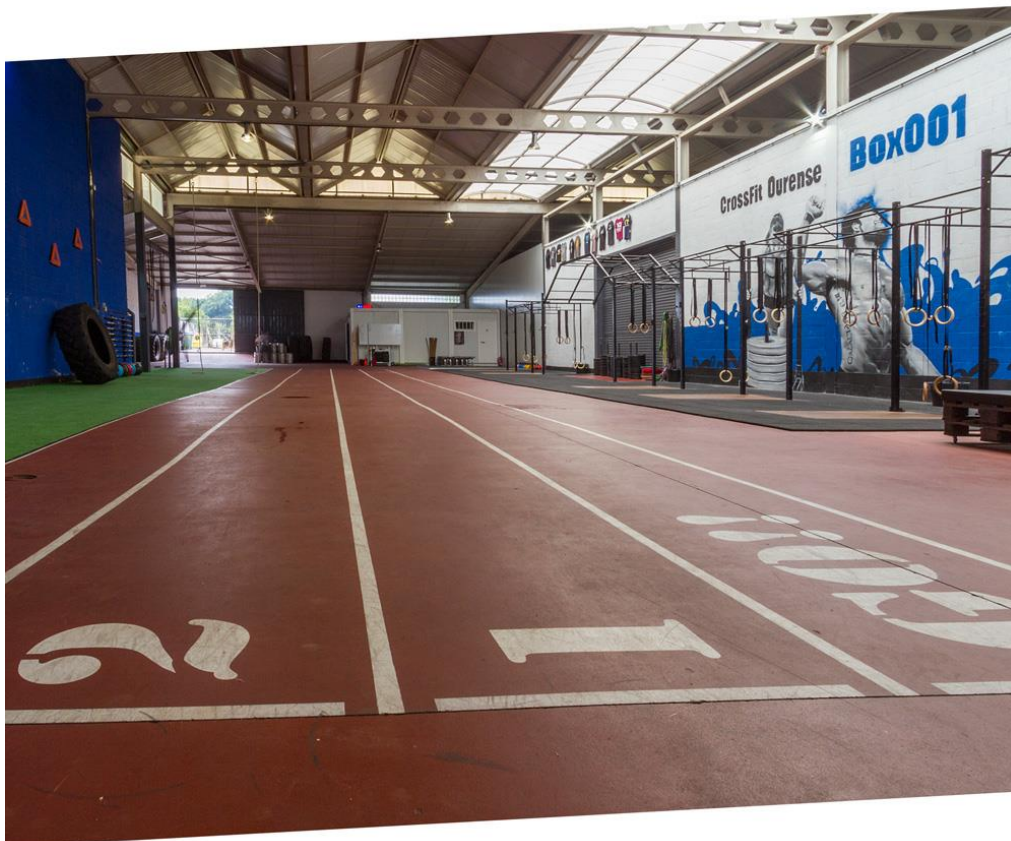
Vigas aligerada en box de CrossFit Ourense
